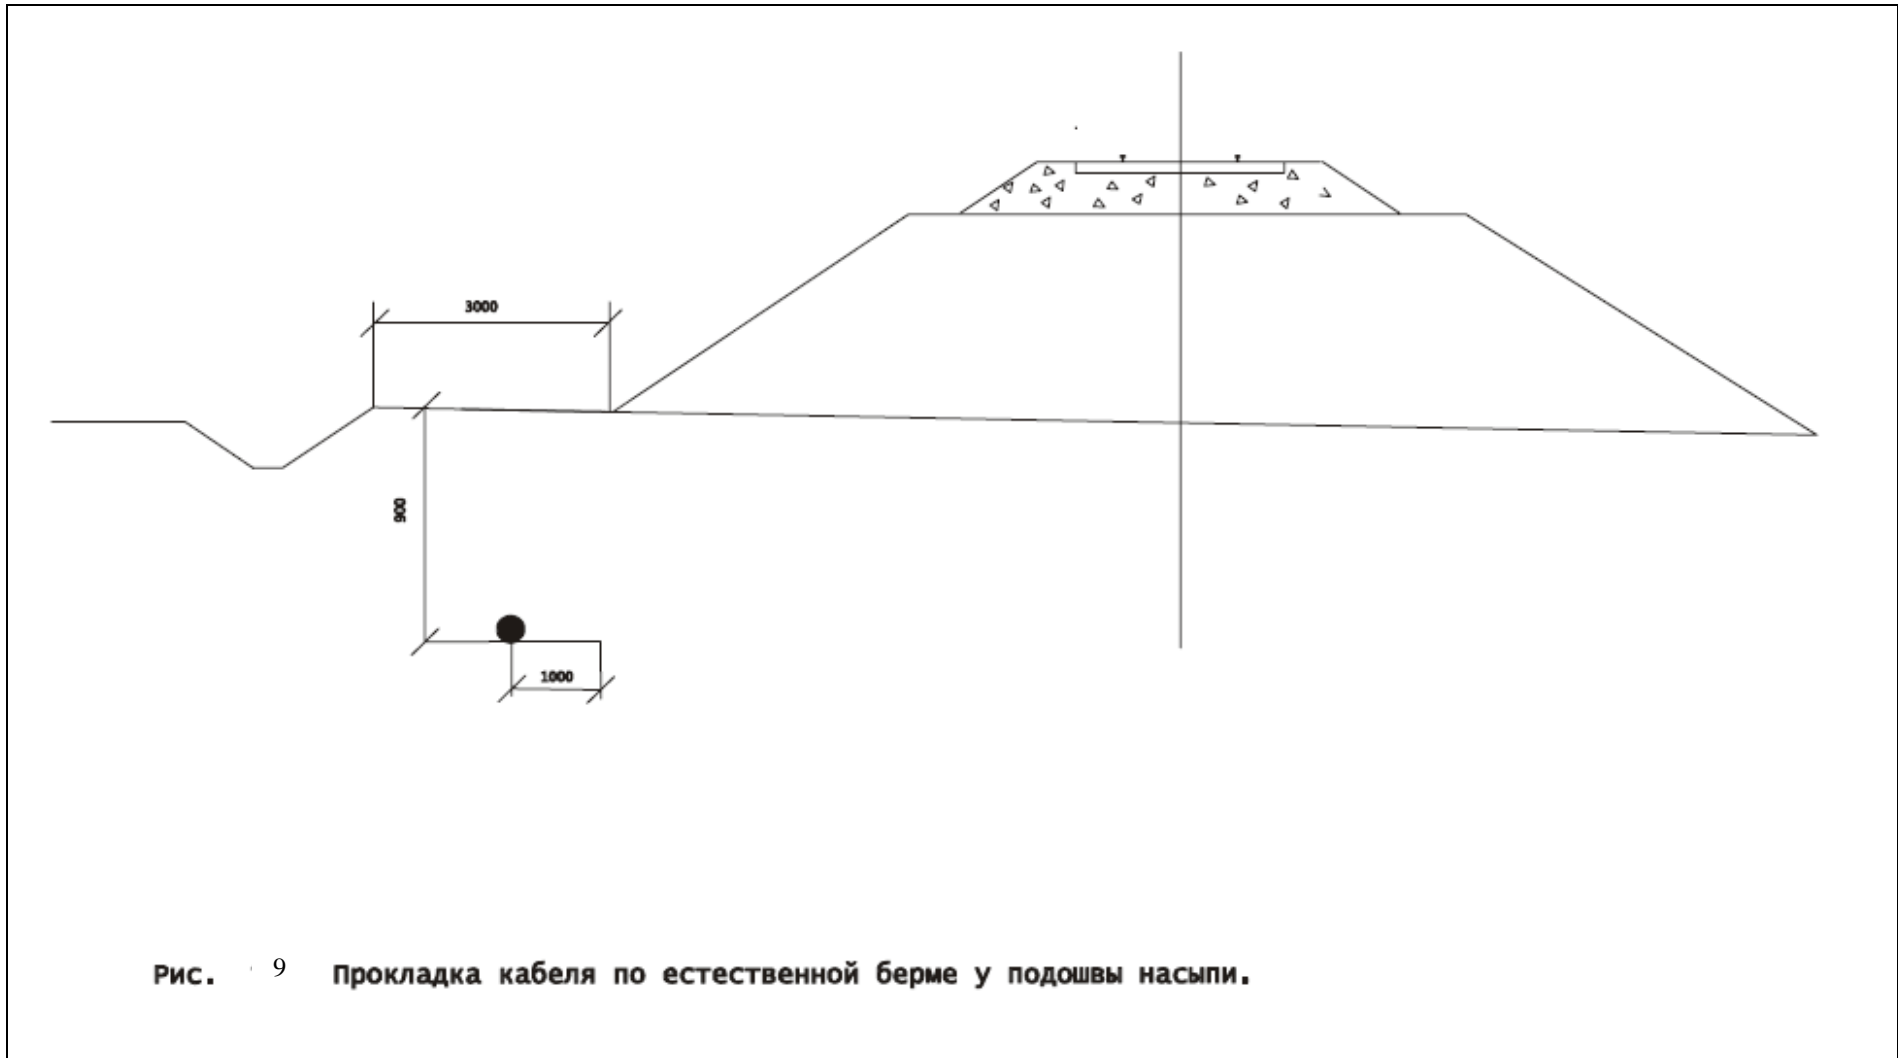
Прокладка кабеля по естественной берме у подошвы насыпи.
